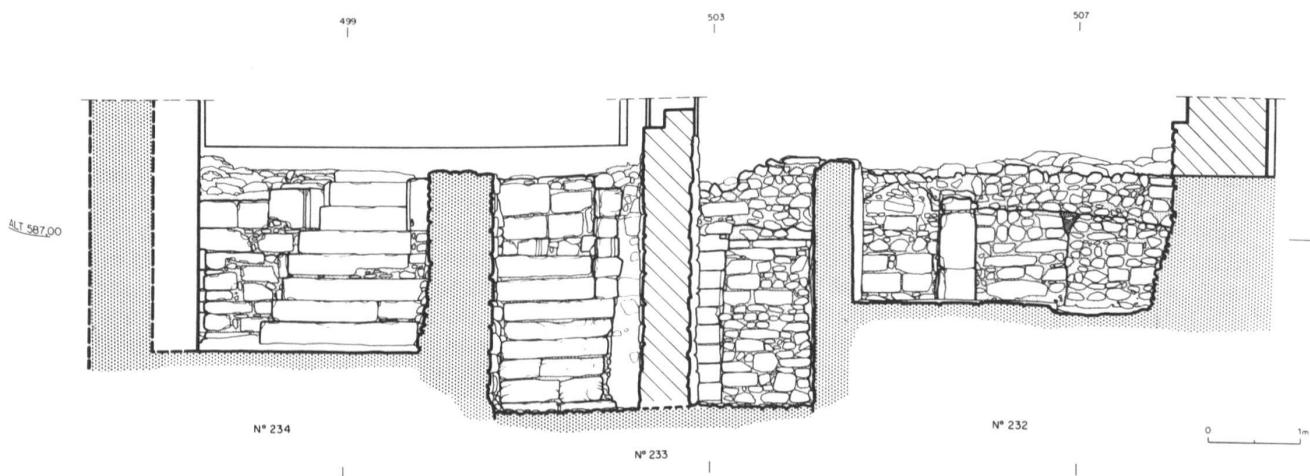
Rue du Pont-Suspendu 74–75. Relevé au pierre à pierre de la face interne de la façade sud des n° 233–235.
